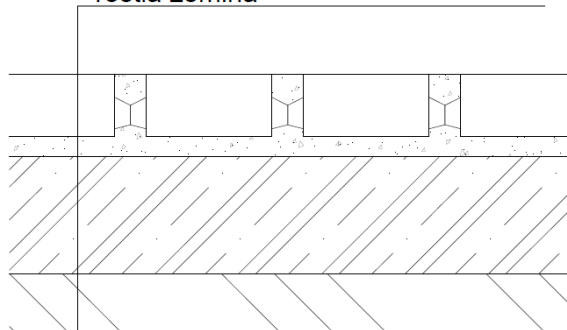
Schéma skladby betonové dlažby (vlastní zdroj)
